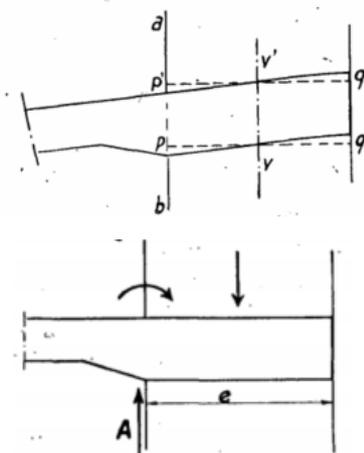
Representación viga empotrada y deformada (Arnaiz, 1930)
